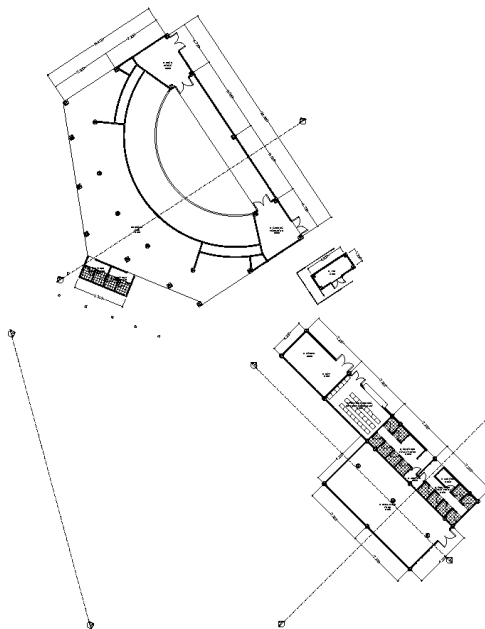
Situasi Blue Lagoon Water Cultural Center
